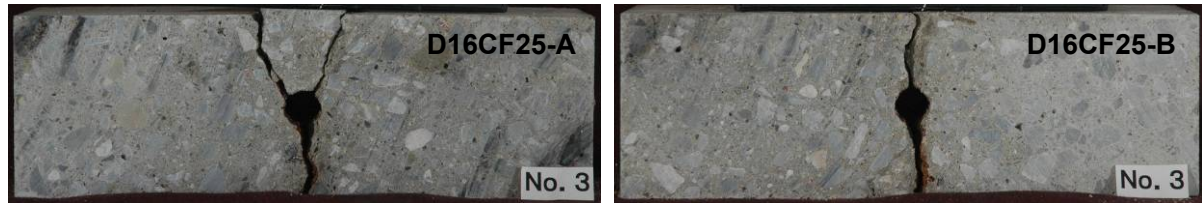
引抜試験後の腐食ひび割れ状況
